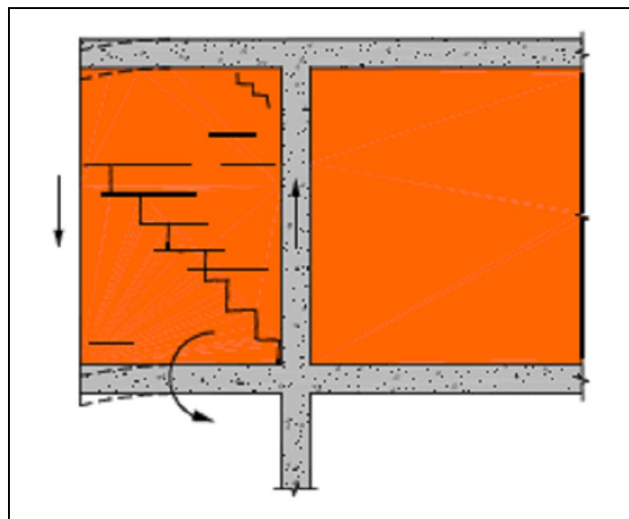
Fissuração nas paredes de compartimentação: deformação de consolas. [37]
